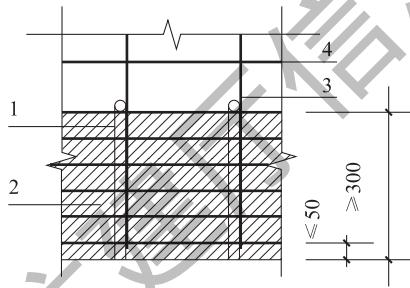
钢筋浆锚搭接连接部位水平分布钢筋加密构造示意图
